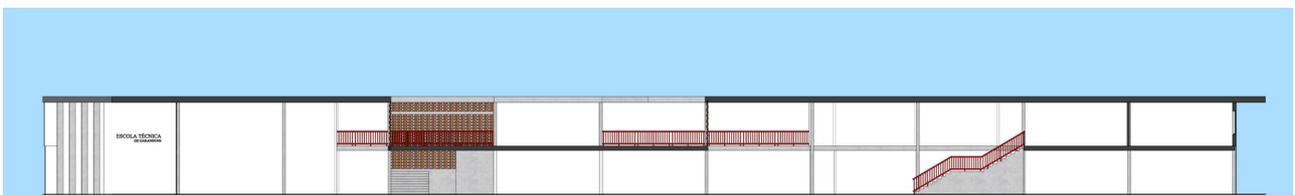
Corte esquemático A-A', destacando um gabarito rígido bem horizontal.
